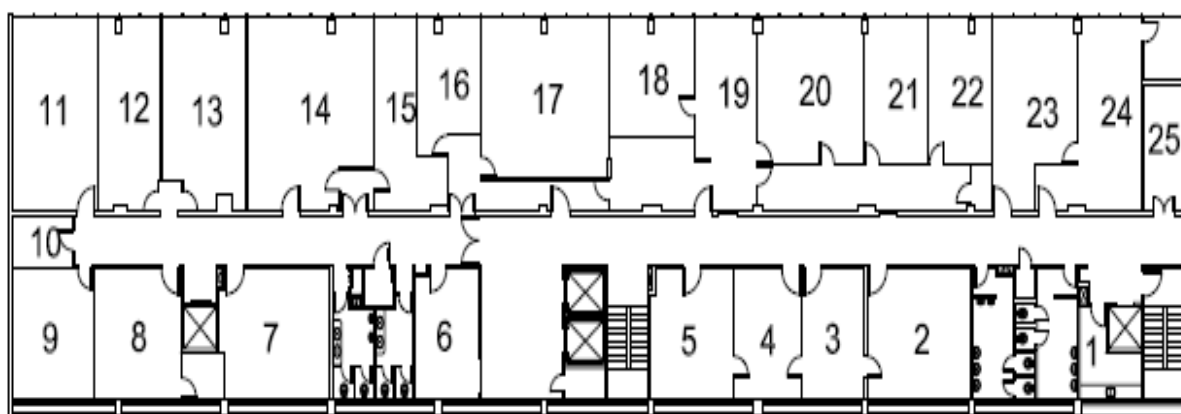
Planta baixa do 8º andar da Reitoria da UFSM.
